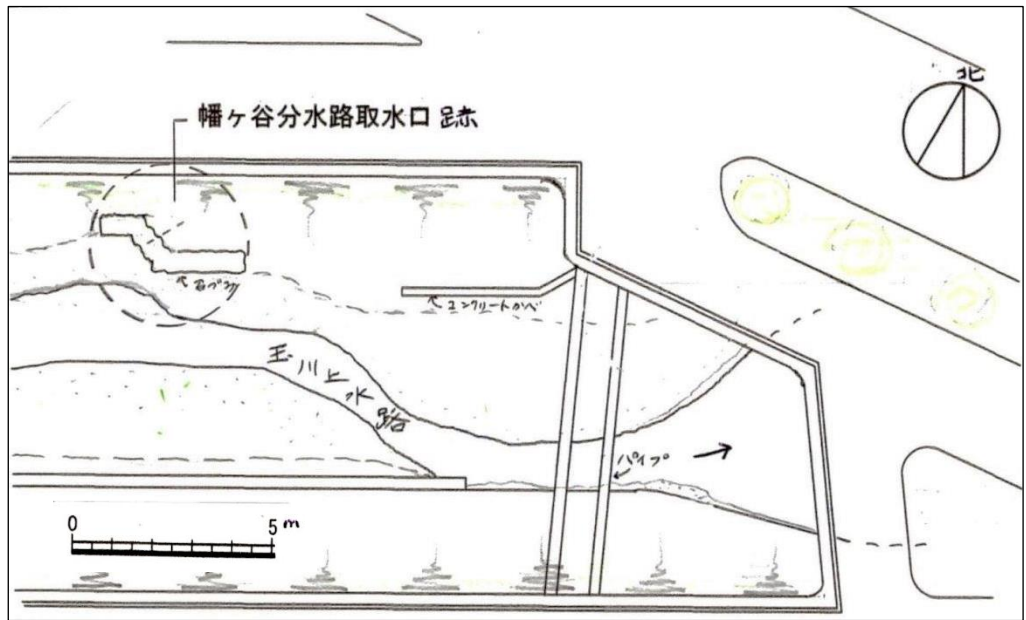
幡ヶ谷分水路取水口平面略図
